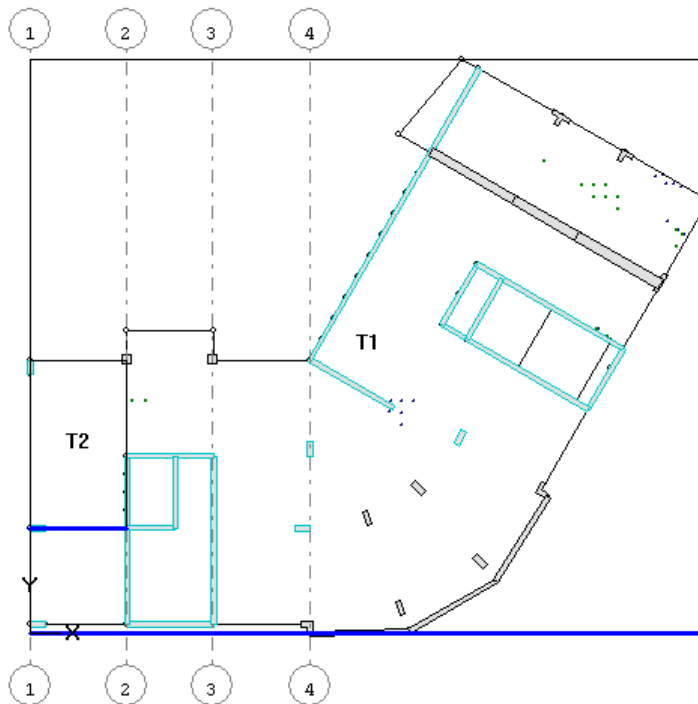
Участки раскладки стержней (основное и дополнительное армирование) с контролем остаточного армирования
